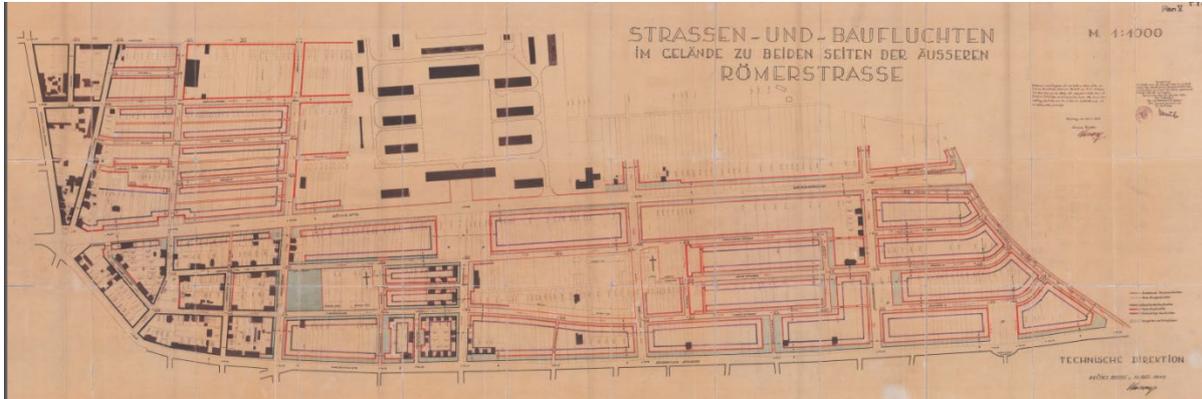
Ausschnitt Straßen und Baufuchtenplan mit Rechtskraft vom 06. April 1950
